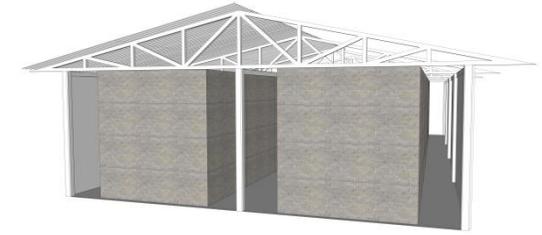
Esquema de nova construção em alvenaria estrutural. Fonte: Elaborado pela autora.
